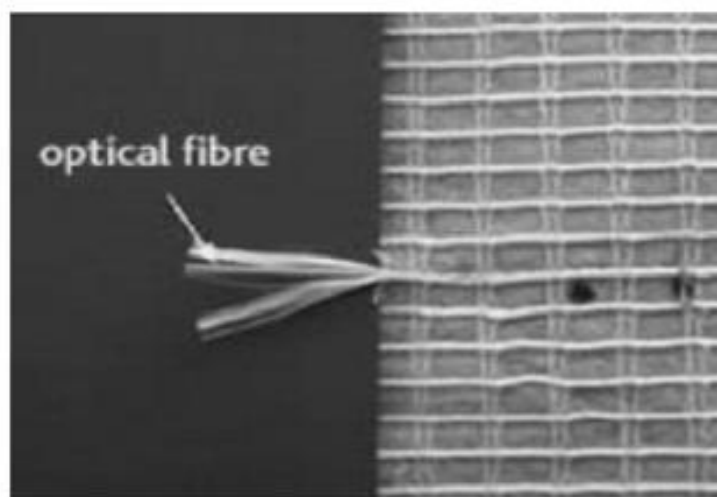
Detalle de la fibra óptica insertada en el geotextil
